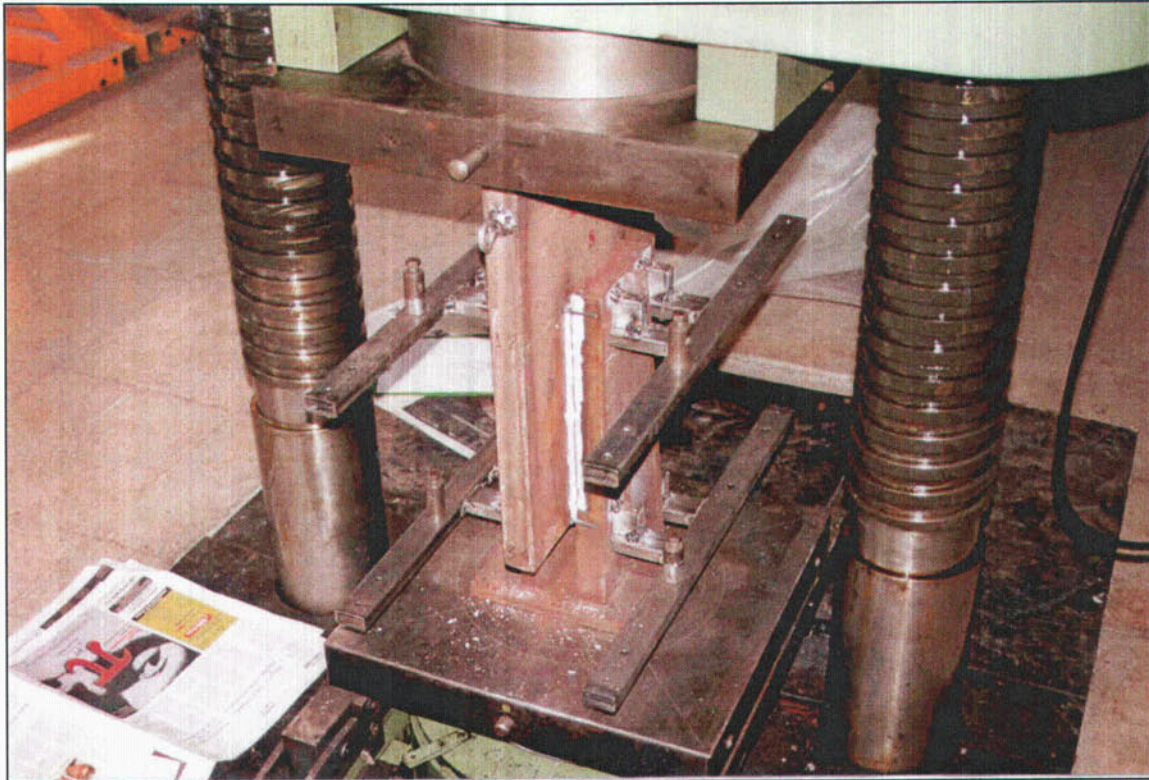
Probeta 5S justamente después de romper en el ensayo en la prensa de compresión. La instrumentación se retiró justo antes de la rotura para evitar dañar los flexímetros. En la fotografía se observa el plano de rotura en la soldadura 2-4.
